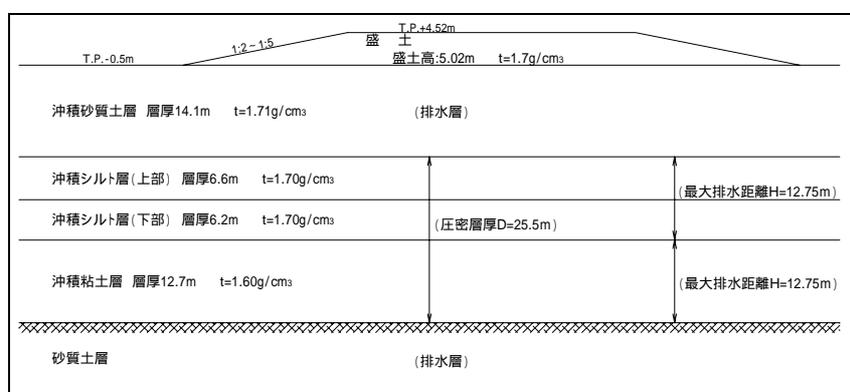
(1) 沈下量計算等標準断面図
